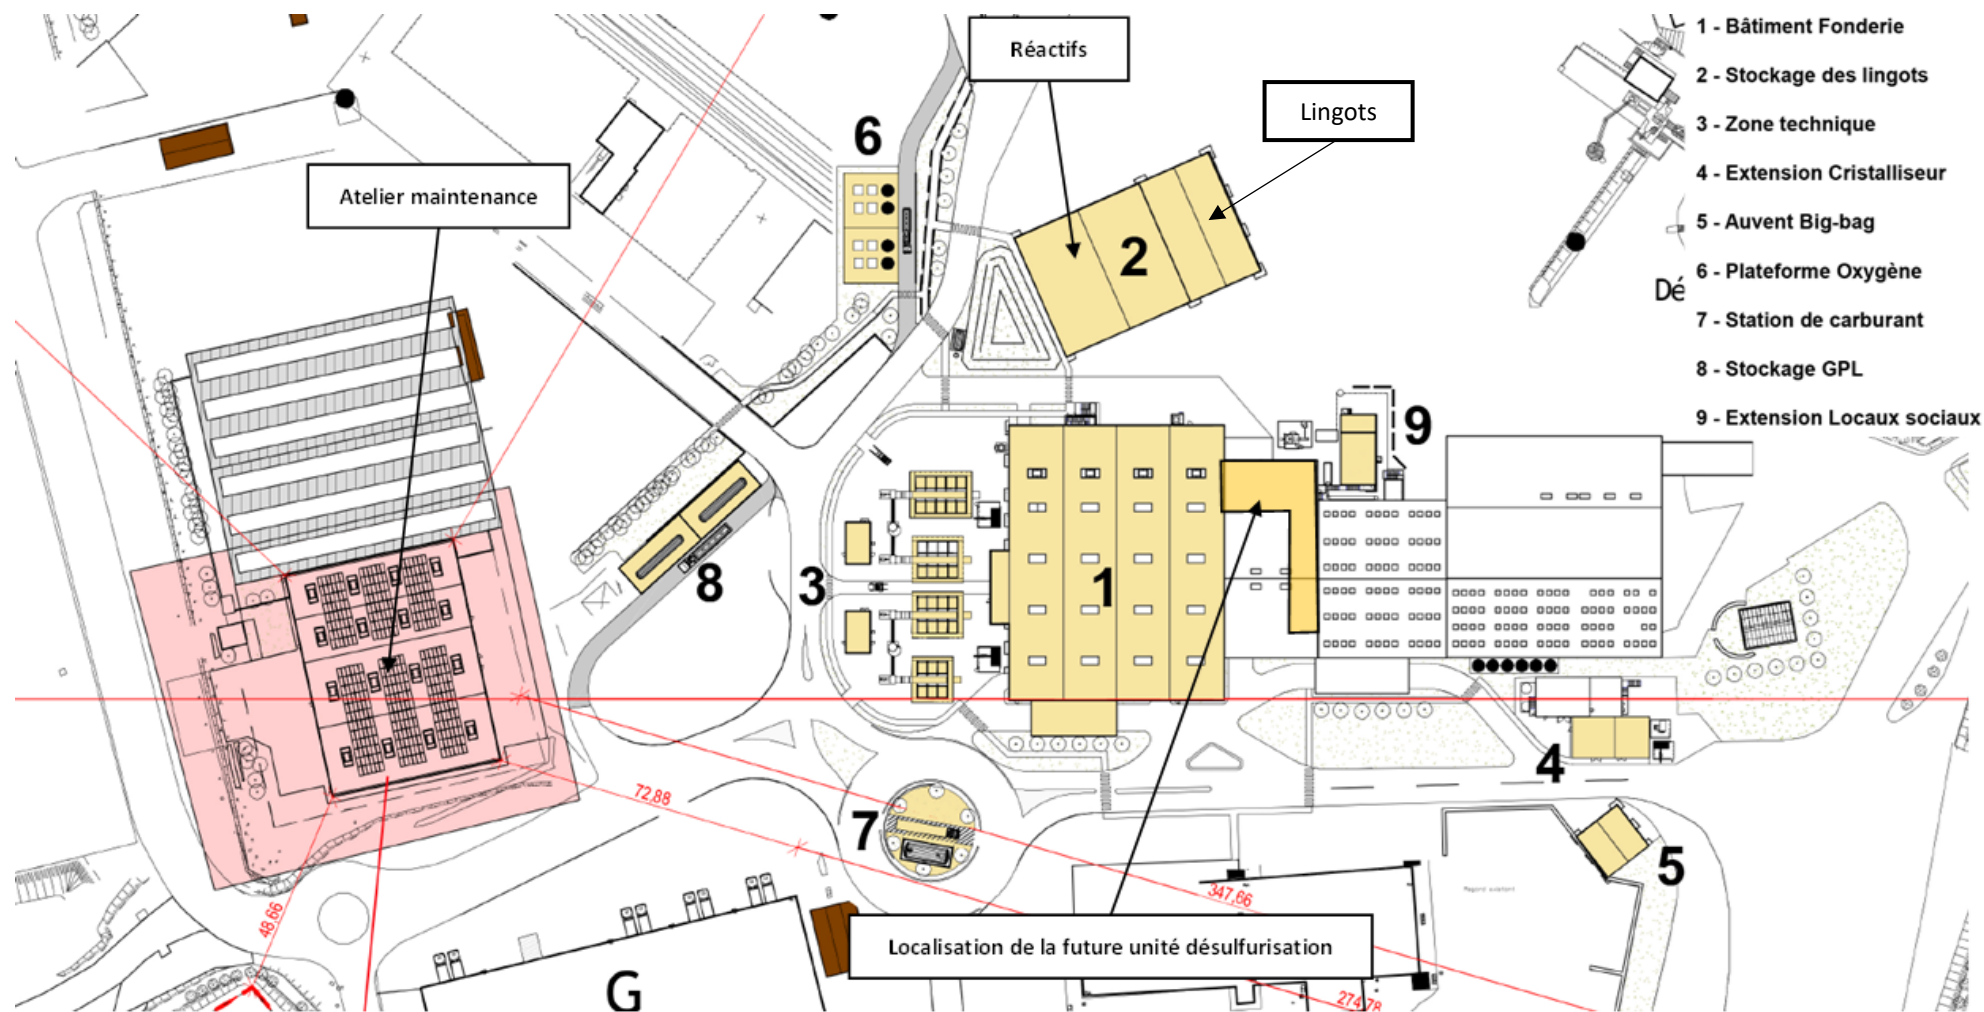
Plan masse prévisionnel - (Plan avec données sensibles et non largement diffusées selon l'instruction du 12 septembre 2023)
